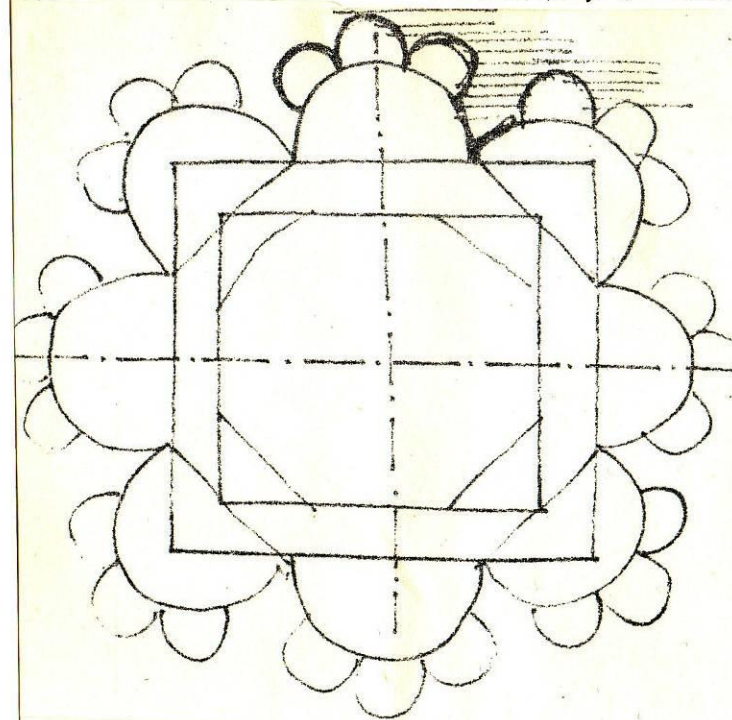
/183: Plan de la Sacristie de l'Eglise Santa Satira Plan Central. Bramante.
